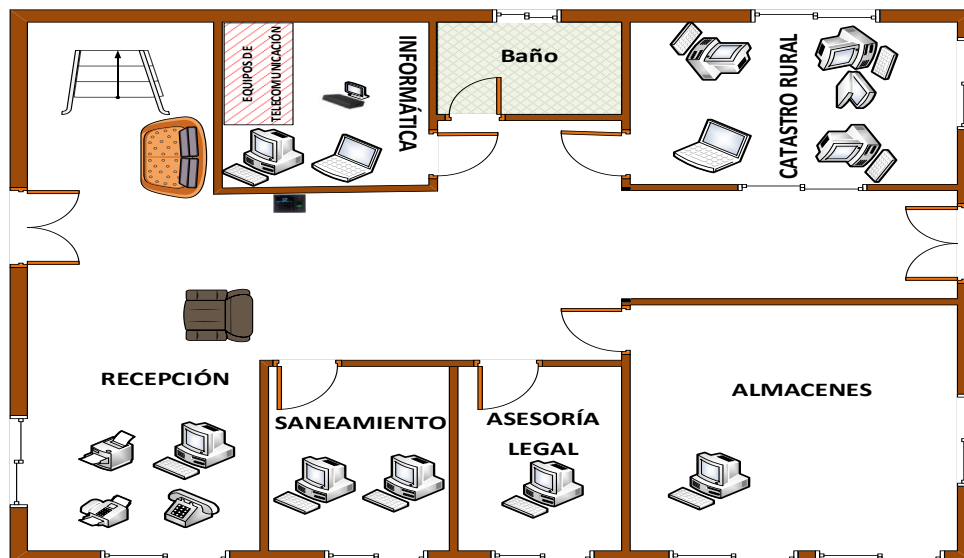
Planos con la ubicación de las estaciones de trabajo planta baja
